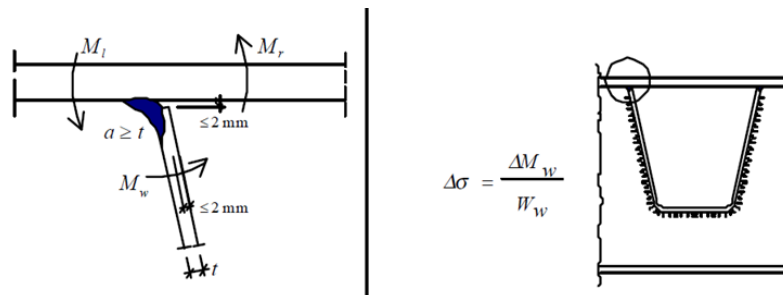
Catégorie de détail : soudure entre tôle de platelage et auget [9].
